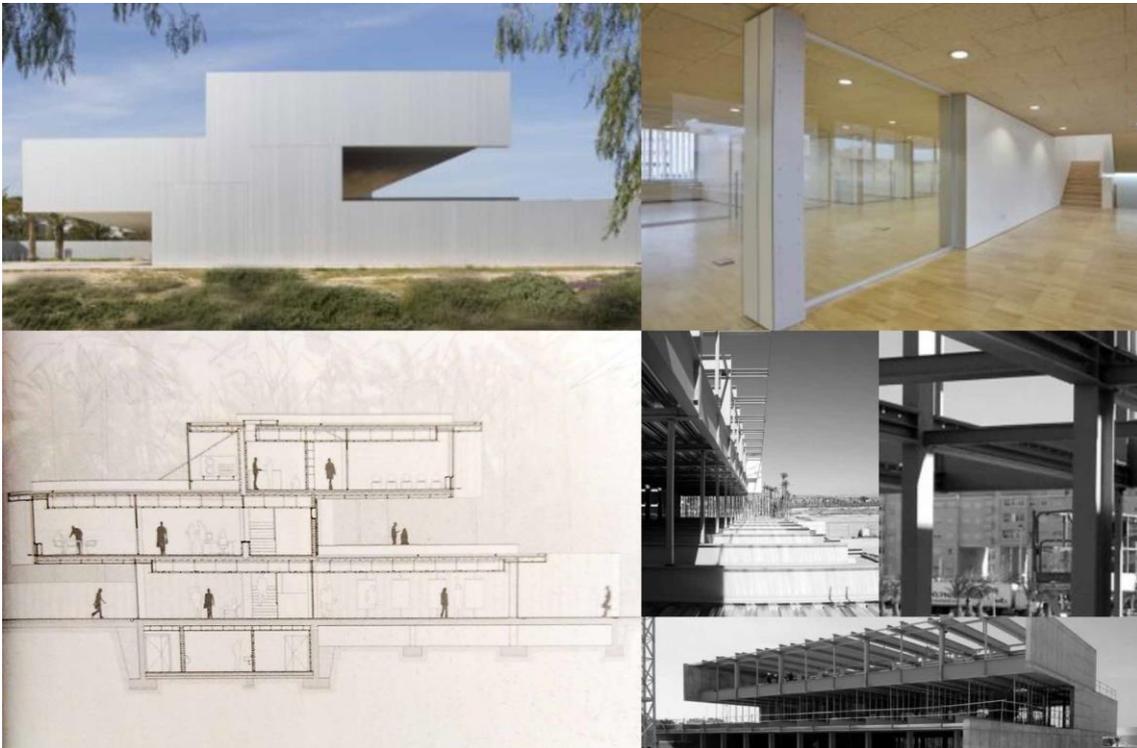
Vista exterior, sección, vista interior y estructura durante el proceso constructivo.
